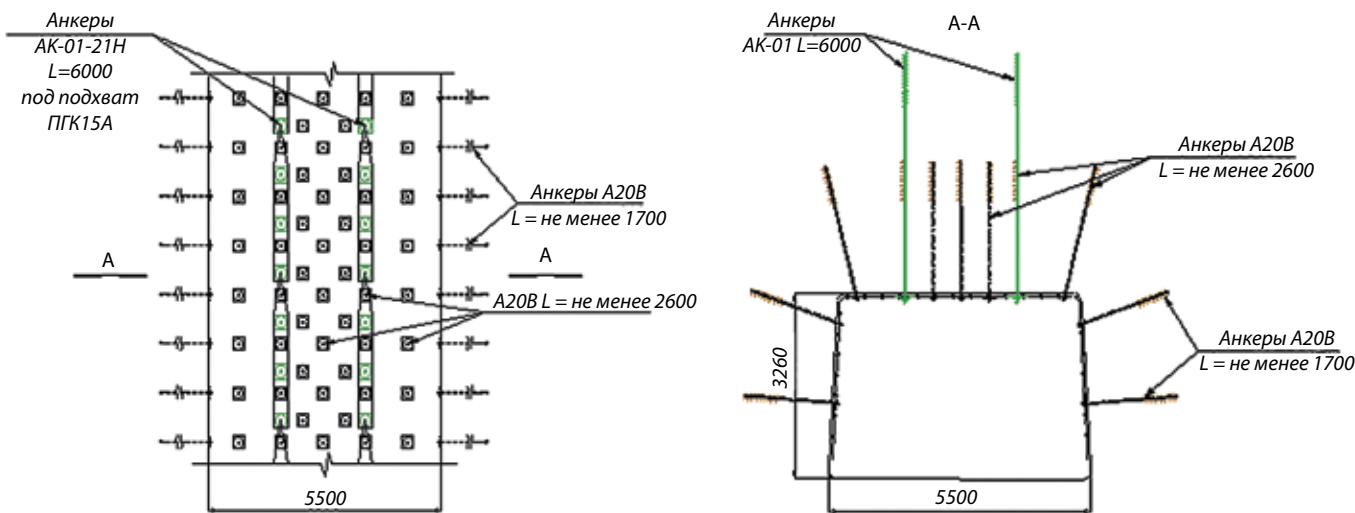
Схема крепления вентиляционного штрека № 26-52 канатными анкерами АК01-21Н с продольными гибкими подхватами ПГК15А
